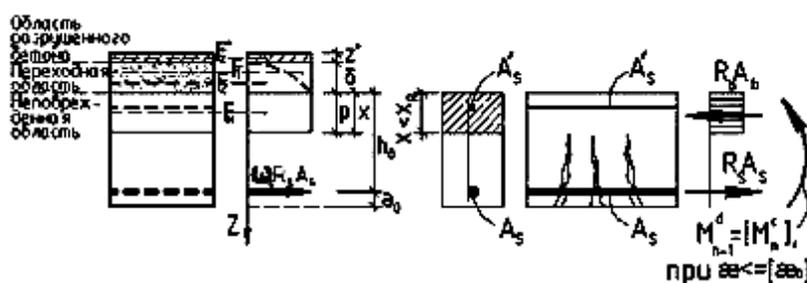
Схема расчетной модели сечения железобетонного элемента балки в запредельном состоянии при пластическом «мягком» случае разрушения
